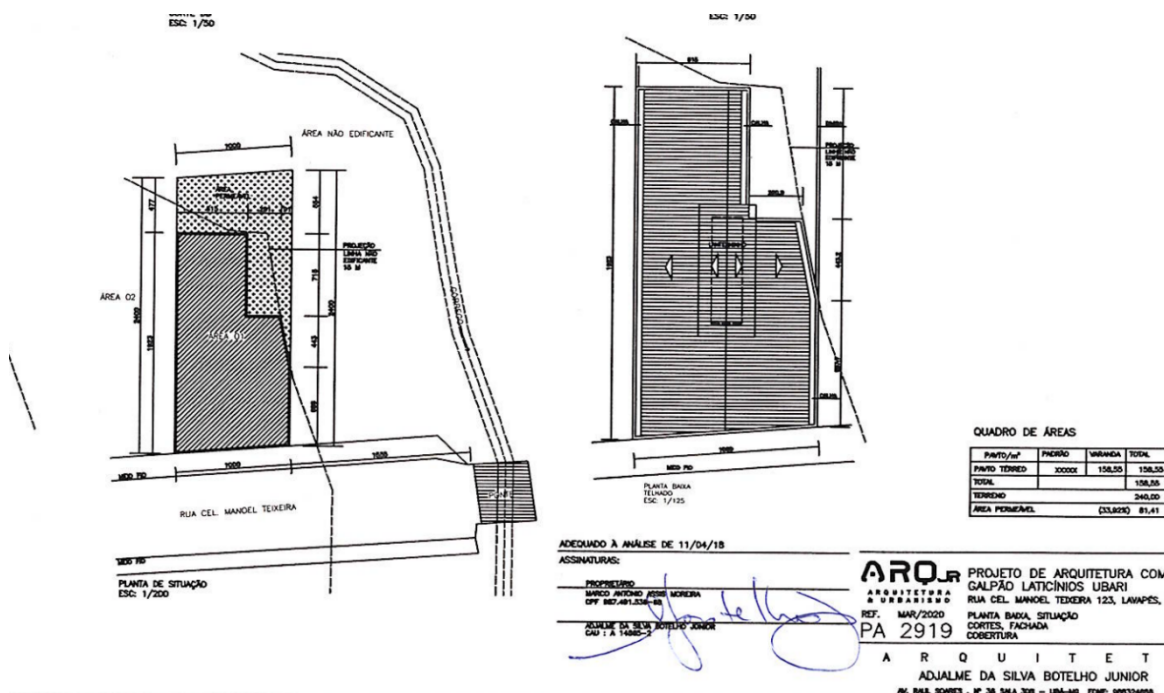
Planta de situação extraída do projeto arquitetônico apresentado no processo URB 686.
